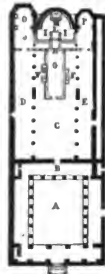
Grundriss von S. Clemente in Rom.
